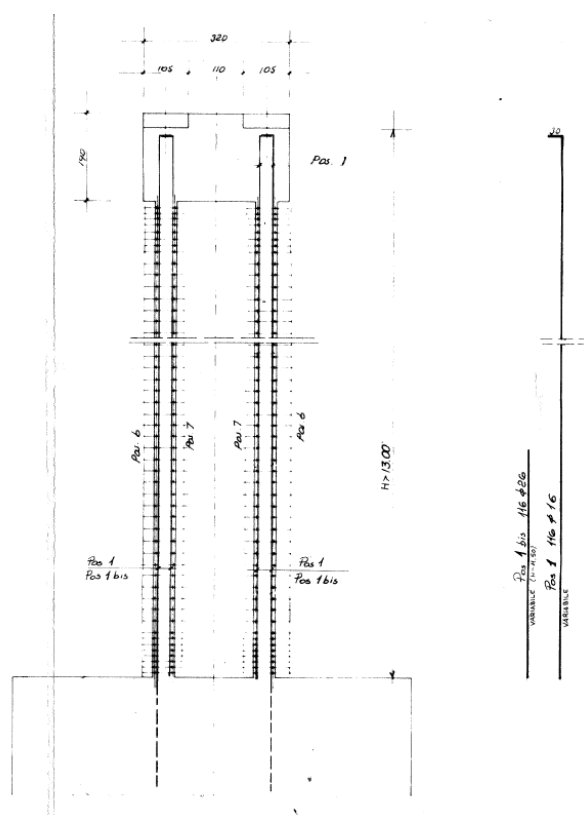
Armature delle pile di altezza maggiore a 13m (da elaborato grafico del progetto dell'epoca)
